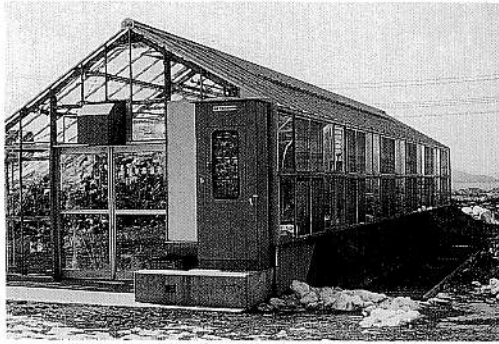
北側の基礎コンクリート部分への土盛りの施工状況
